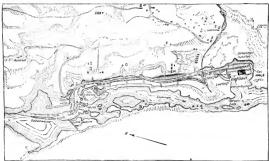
, Lageplan der Wasserwerksanlage. - Masstab 1:10000.
